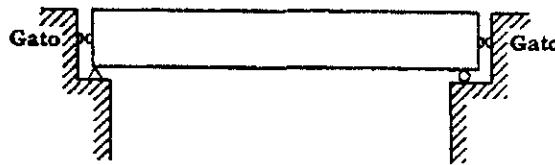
Preesforzado de una viga de concreto simple al colocar gatos contra los estribos
